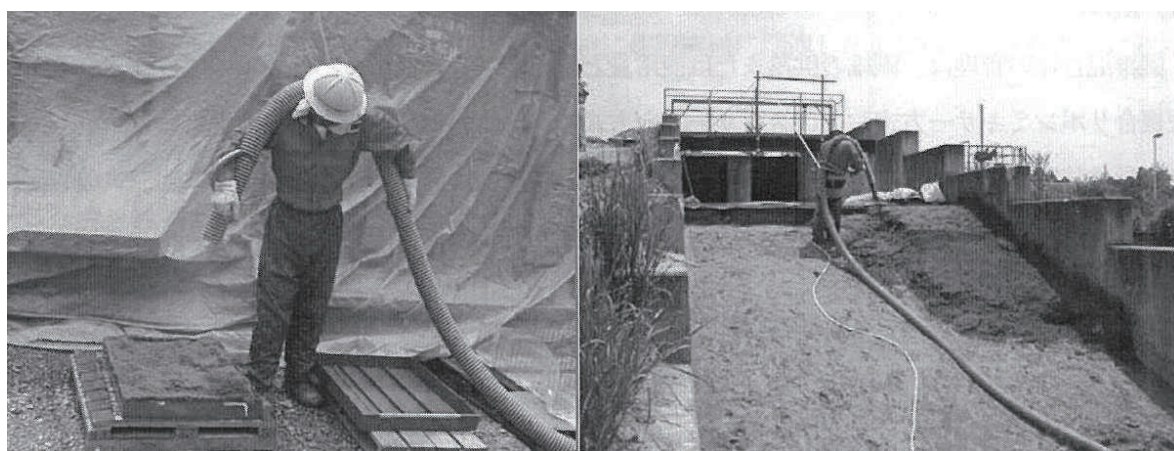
強制攪拌方式（圧送吹付）の施工状況
